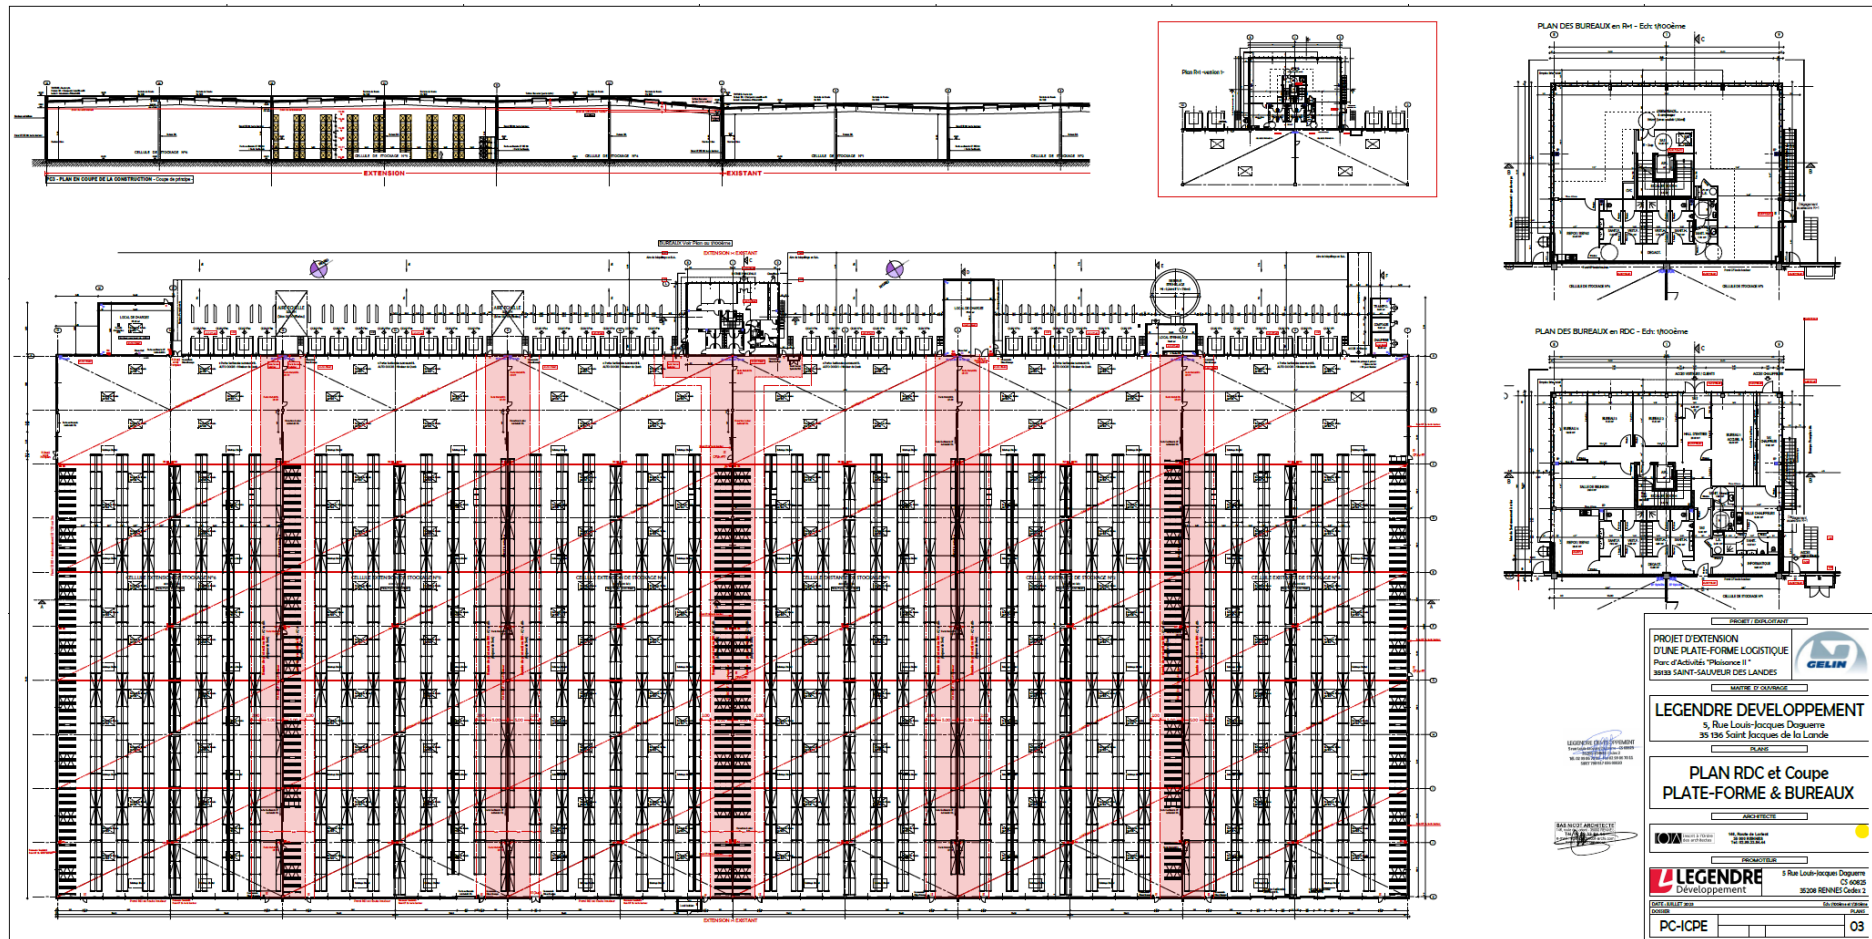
Plan de RDC (source : NICOT ARCHITECTE)
